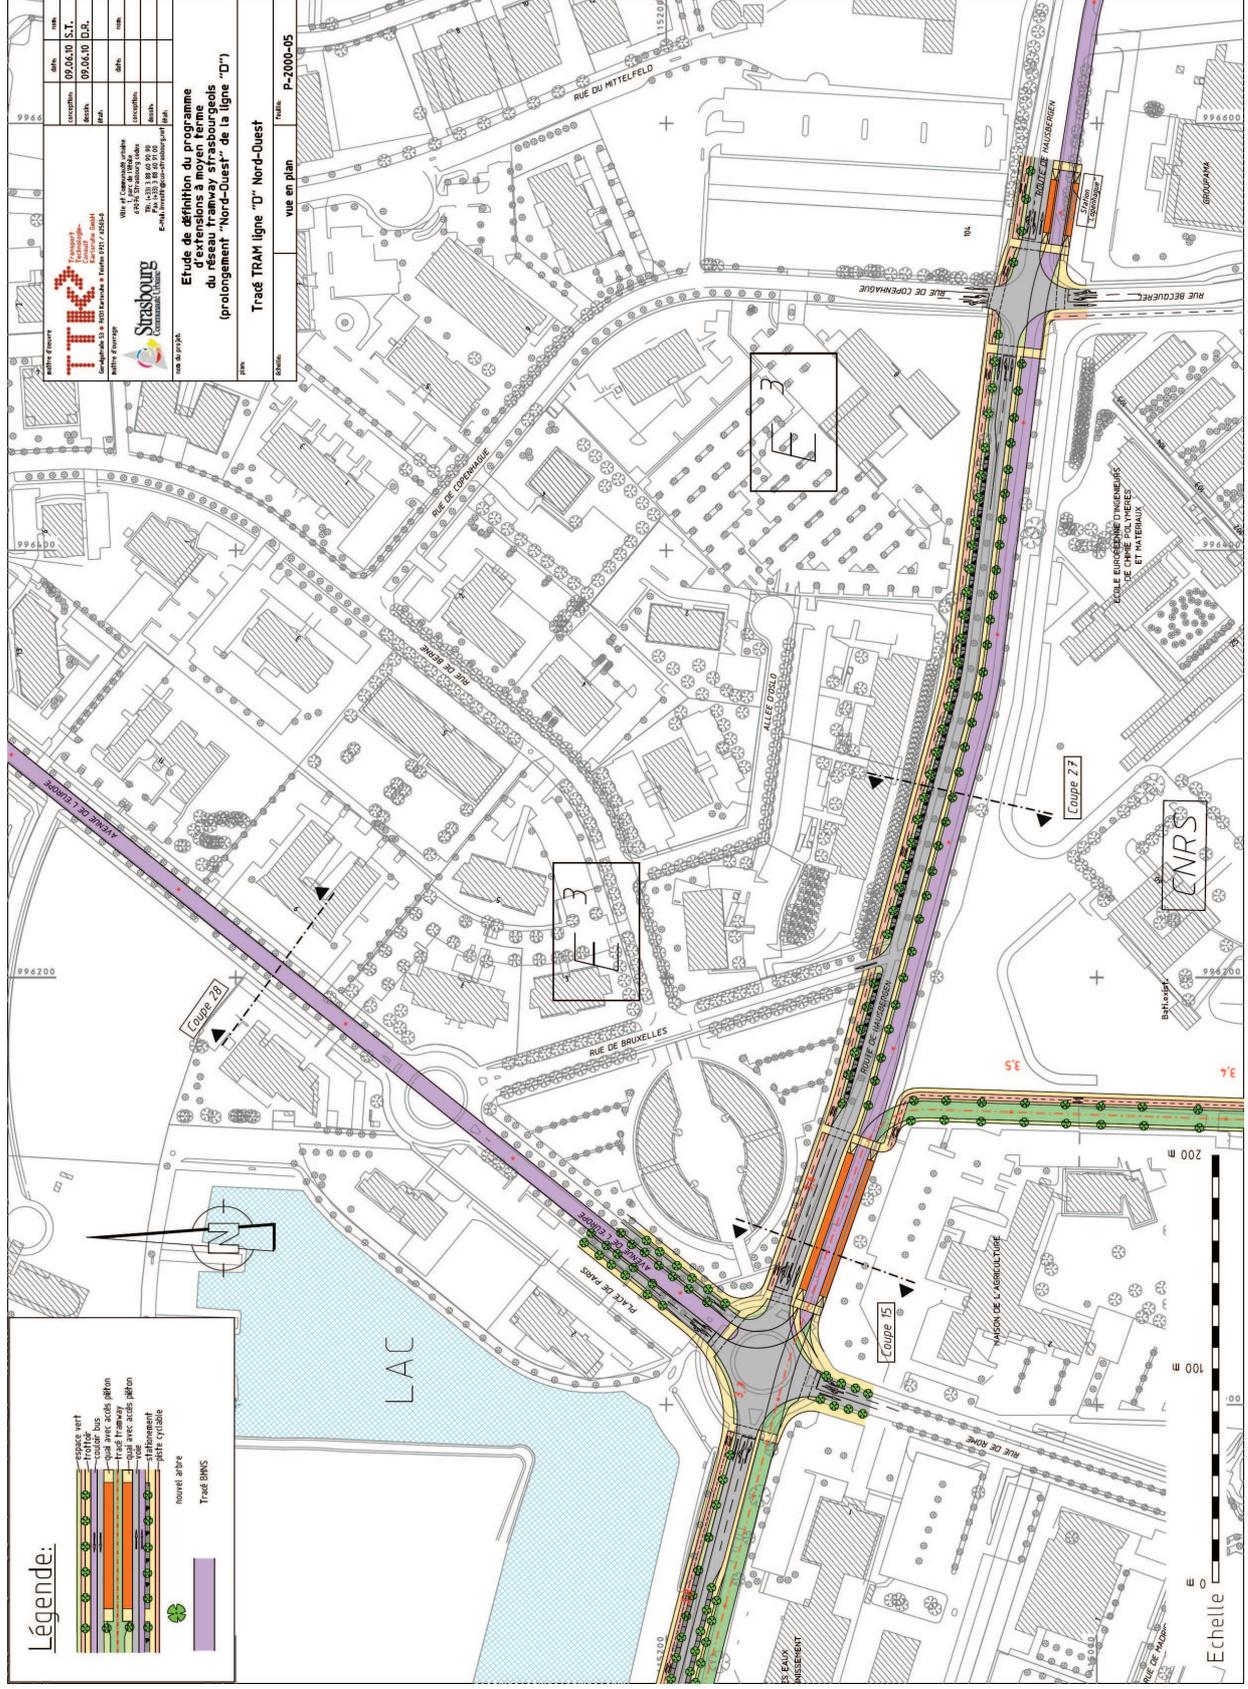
Plan d'insertion secteur route Hausbergen (échelle 1/2500<sup>ème</sup>)
